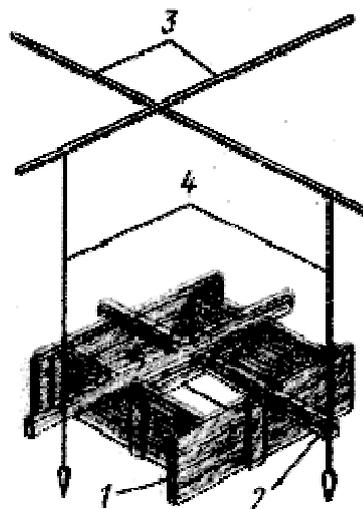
Порядок установки опалубки фундамента прямоугольного под колонны:
